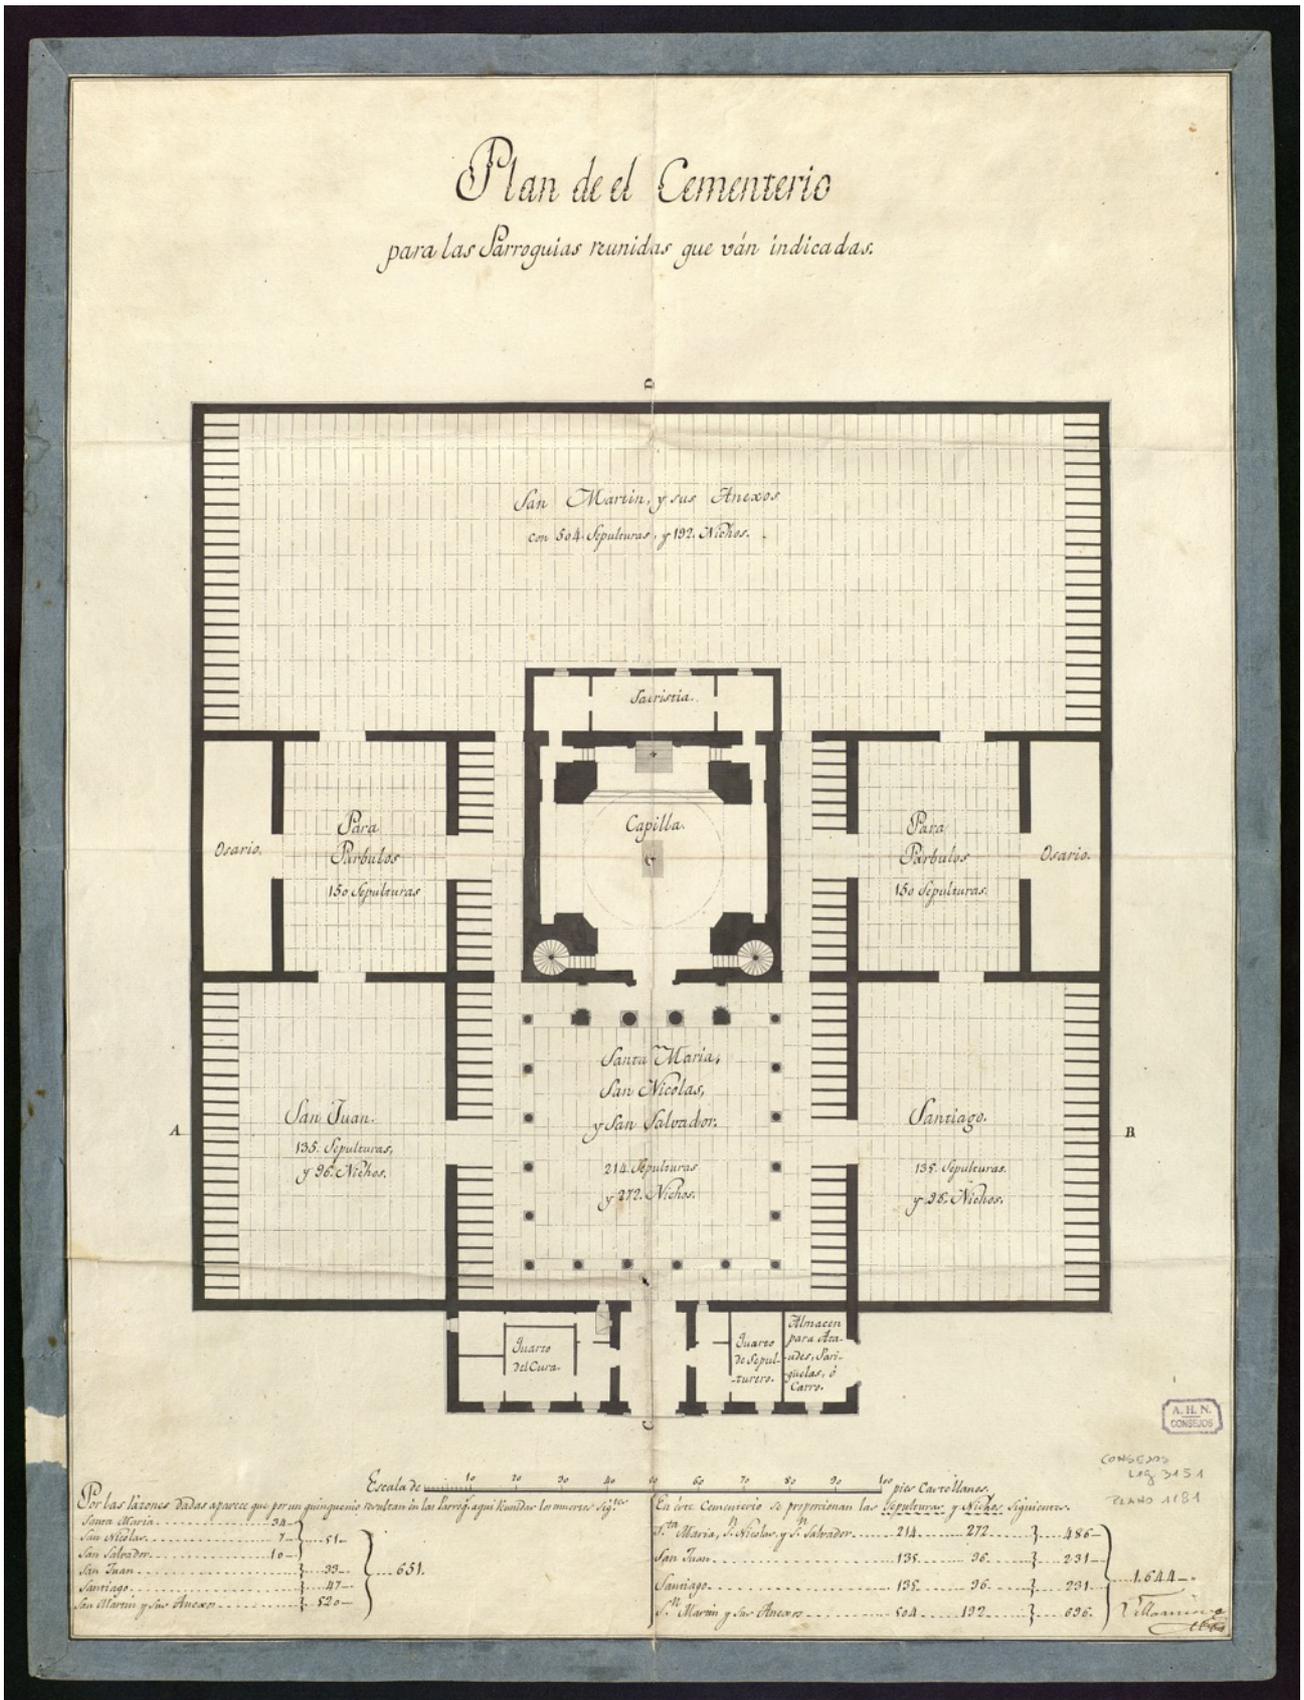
Plano del cementerio del Norte de Madrid, 1804. Juan de Villanueva, arq.
